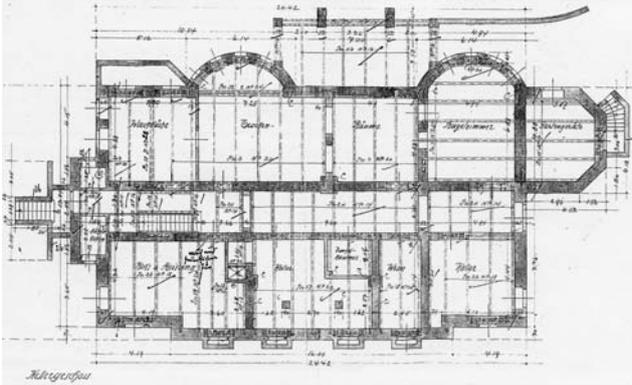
H. Plange, Grundriss Kellergeschoss, 1913
